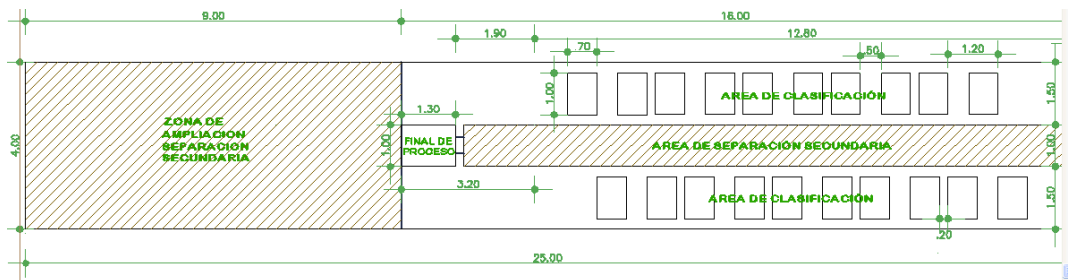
Vista arquitectónica de separación secundaria de la planta de reciclaje
